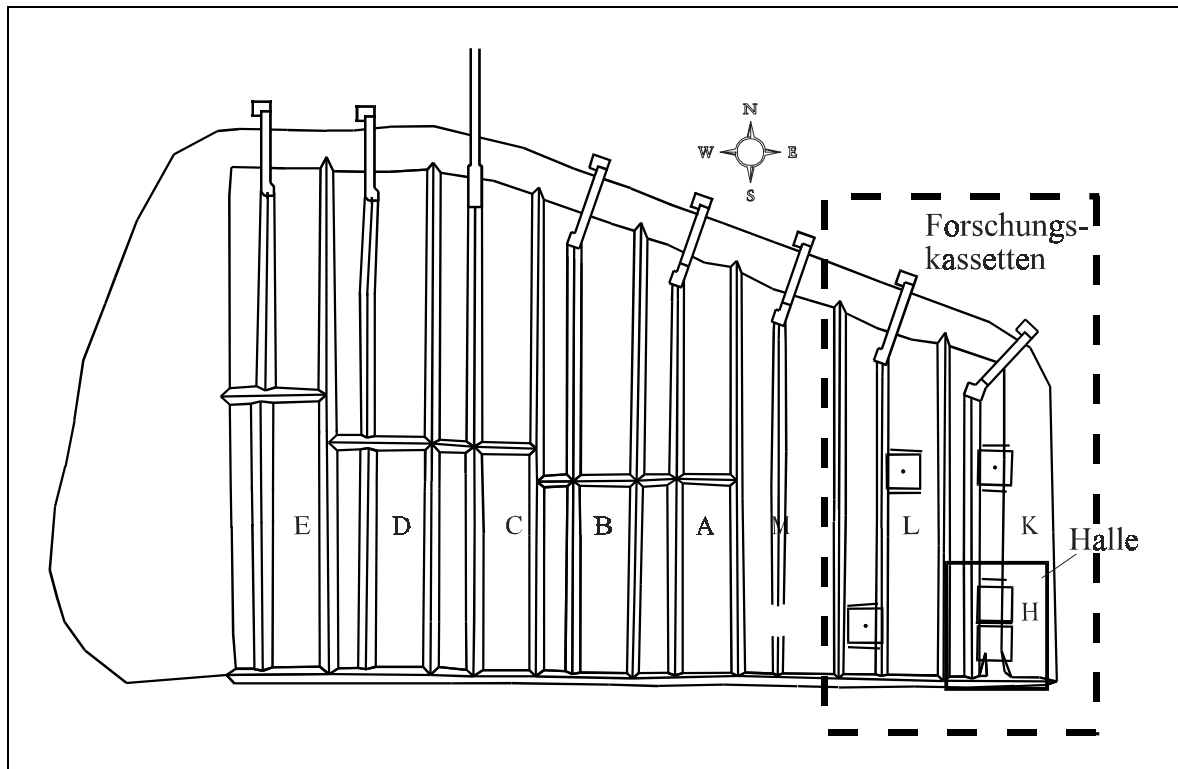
Lageplan der Sonderabfalldeponie Raindorf
